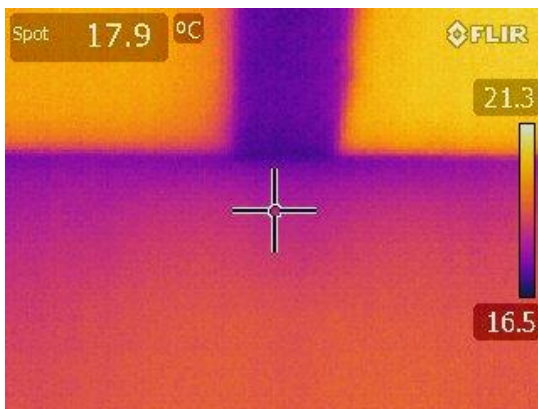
Infiltraciones por unión de fábrica de bloque y entrepiso (techo de planta baja).
